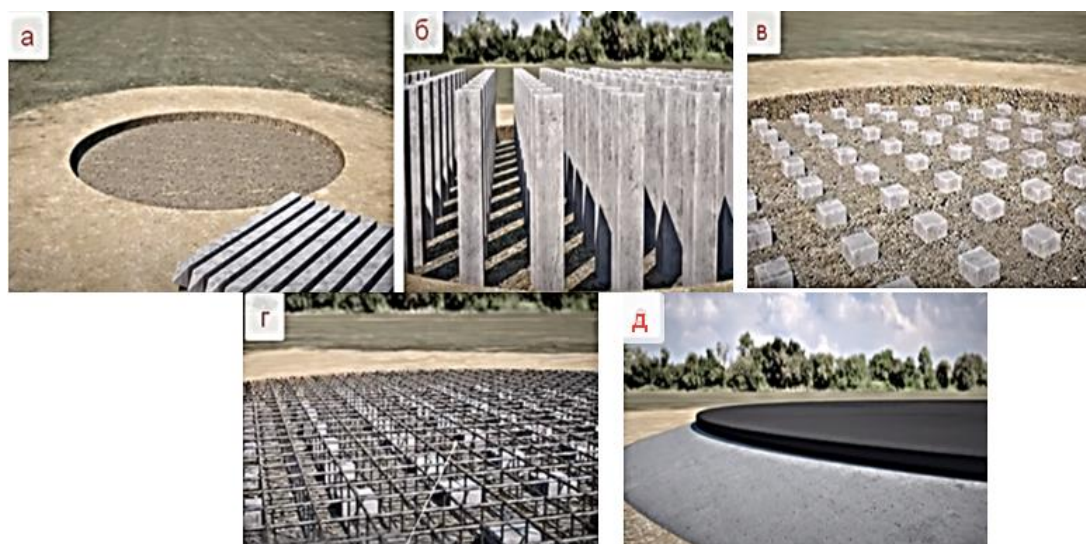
Последовательность устройства монолитного фундамента на свайном основании: а — разработка котлована; б, в — погружение готовых железобетонных свай; г — устройство арматурного каркаса фундамента; д — монолитный железобетонный фундамент (<https://yandex.ru/video/preview/?filmId=10239757162125418555&from=tabbar&parent-reqid=1647766969131568-6746194138223389736-sas3-0749-7ac-sas-l7-balancer-8080-BAL-4229&>)
